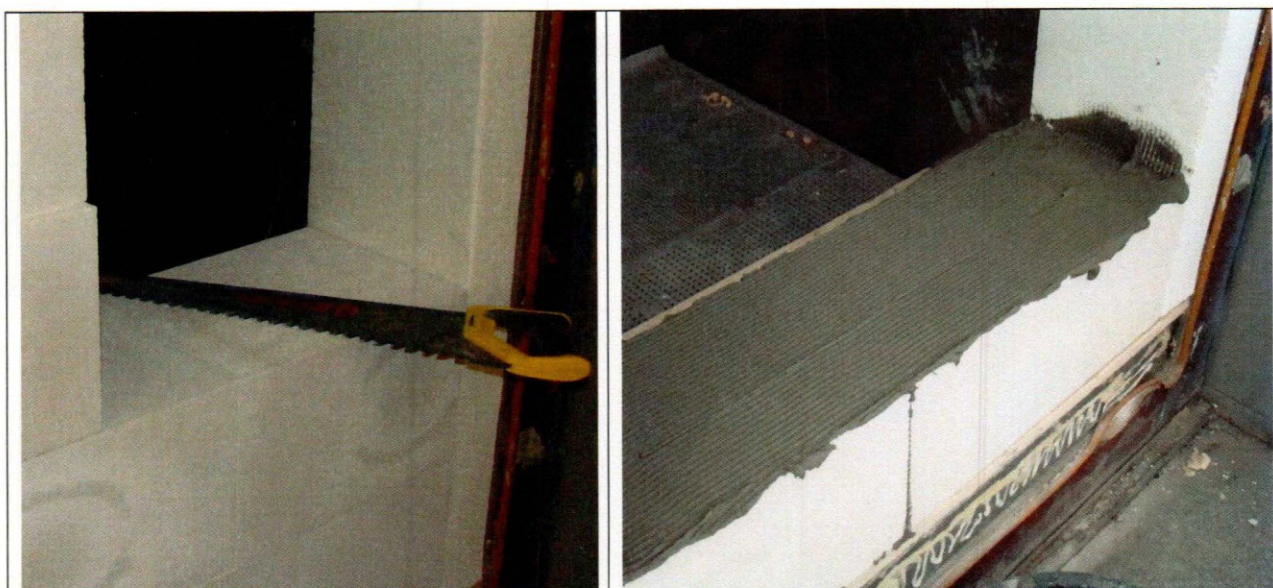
Подготовка и устройство фрагмента кладки из блоков стеновых неармированных из ячеистого бетона на клею
